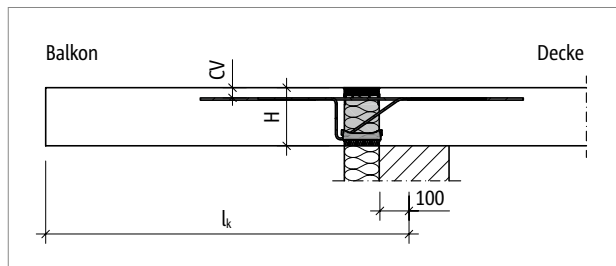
Schöck Isokorb® XT Typ K-M1 bis M10: Statisches System
